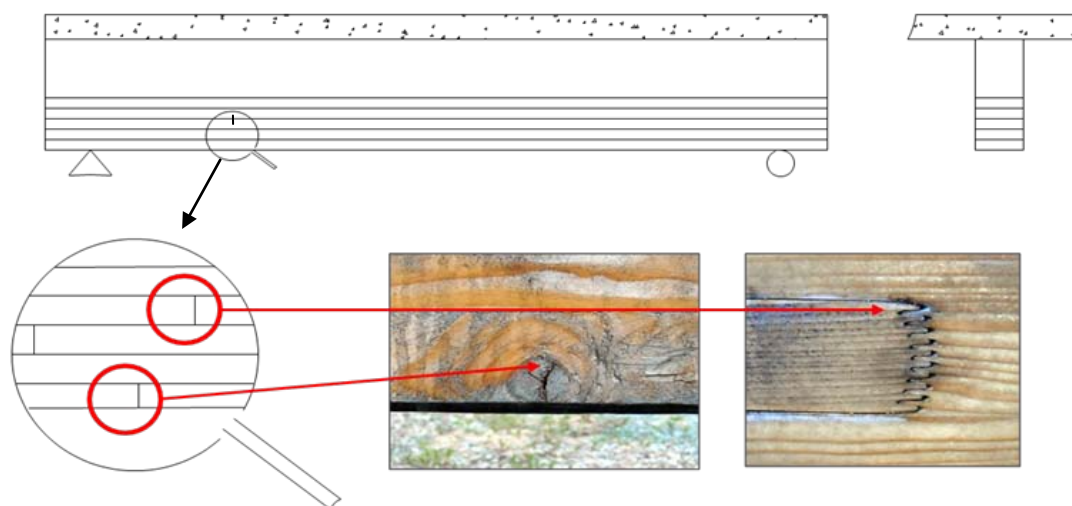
Proposition du multi renforcement (ou multi lamage)
